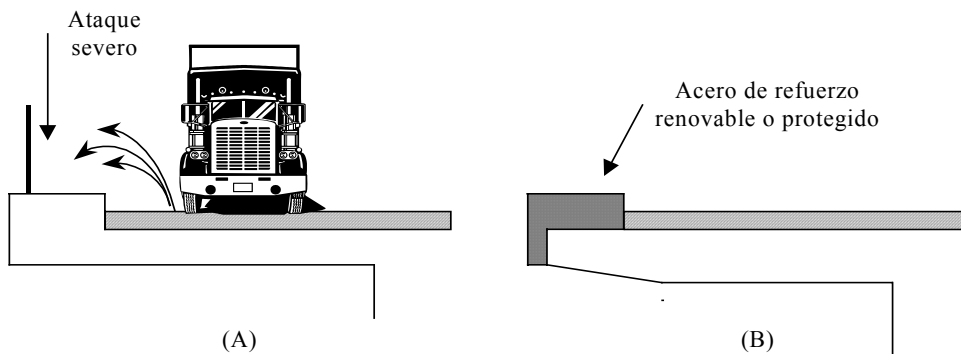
Salpicaduras al concreto: (A) Situación de ataque severo, muy común, (B) Protección agregada.
